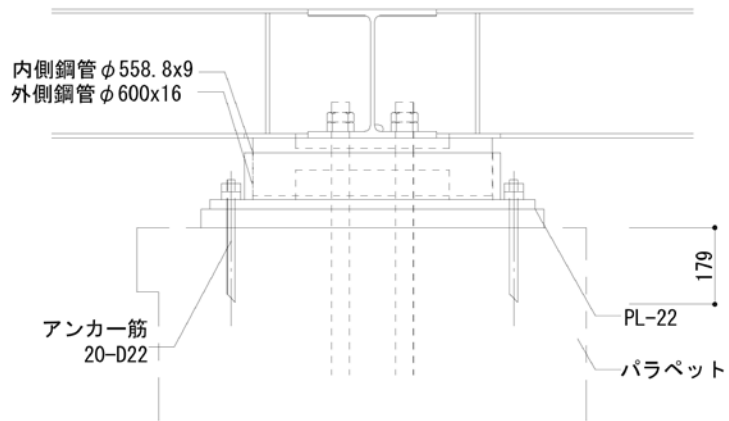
補強鋼管とあと施工アンカー詳細 (断面)
